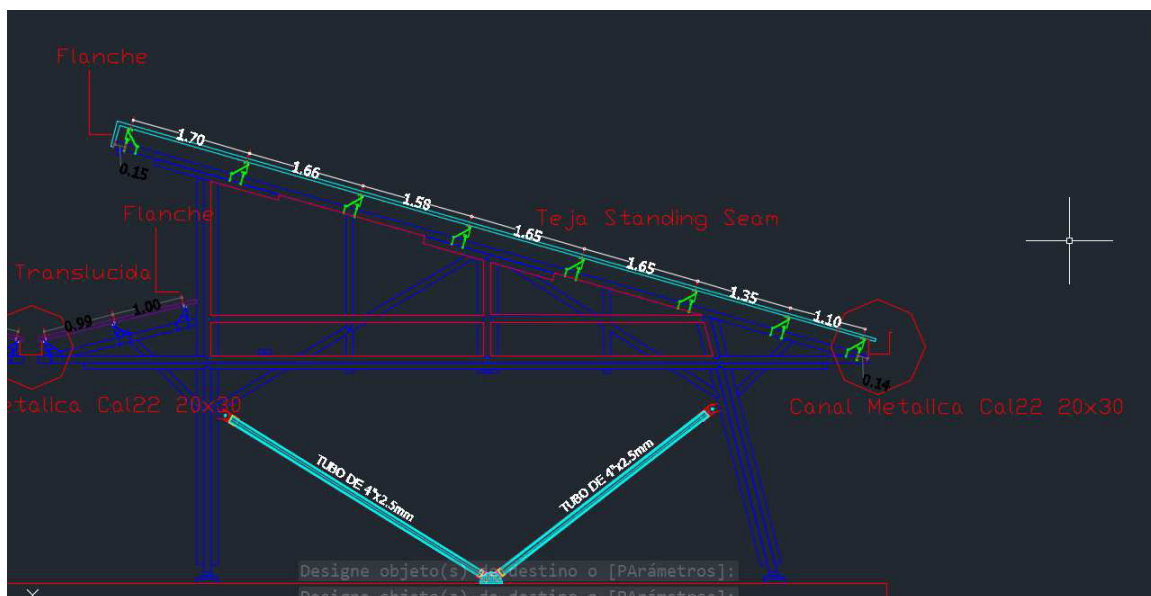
detalle de cubierta “plano estructural 10 de 14”
